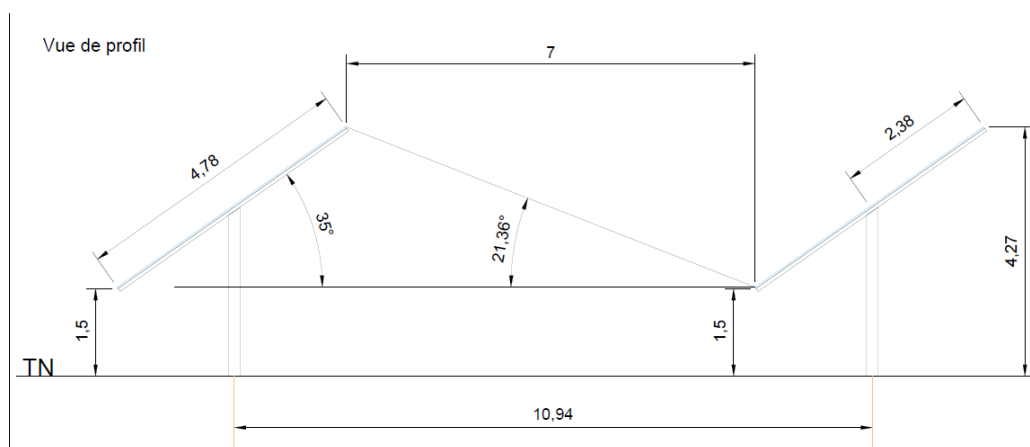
Structures pour le pâturage des ovins sur la zone A et B1 (fixe)
